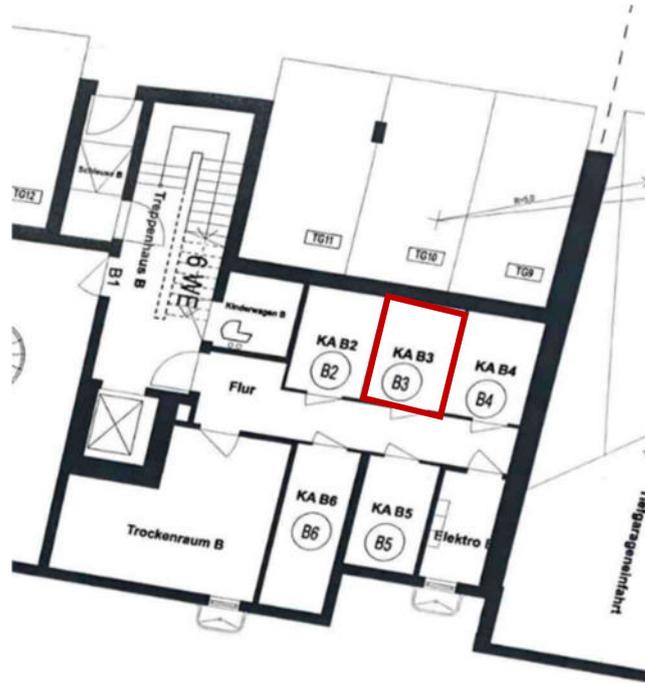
Auszug aus dem Grundriss (Kellergeschoss)
